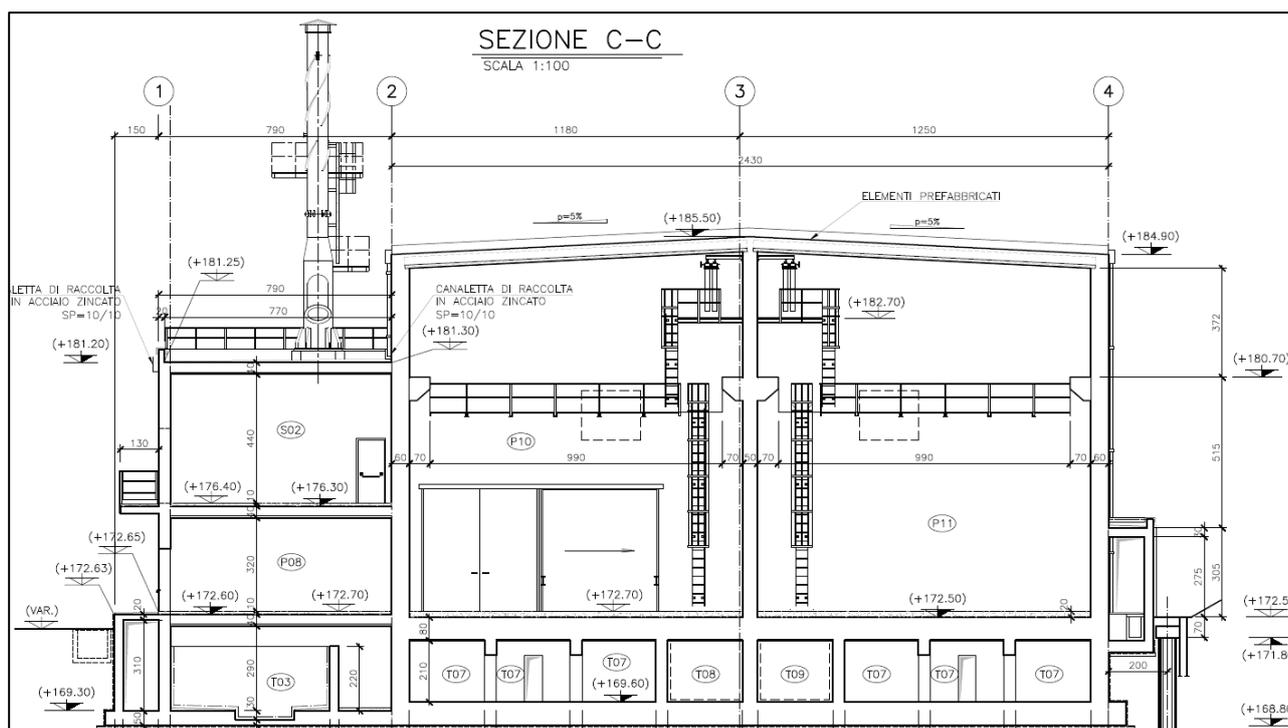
Nuovo deposito 2300: sezione tipica trasversale
